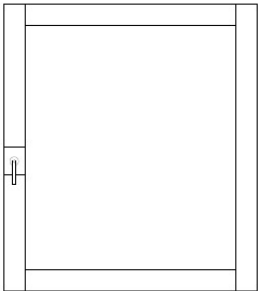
Detail ONE S Schema A anschlagseitig unten mit Anschlussflansch
